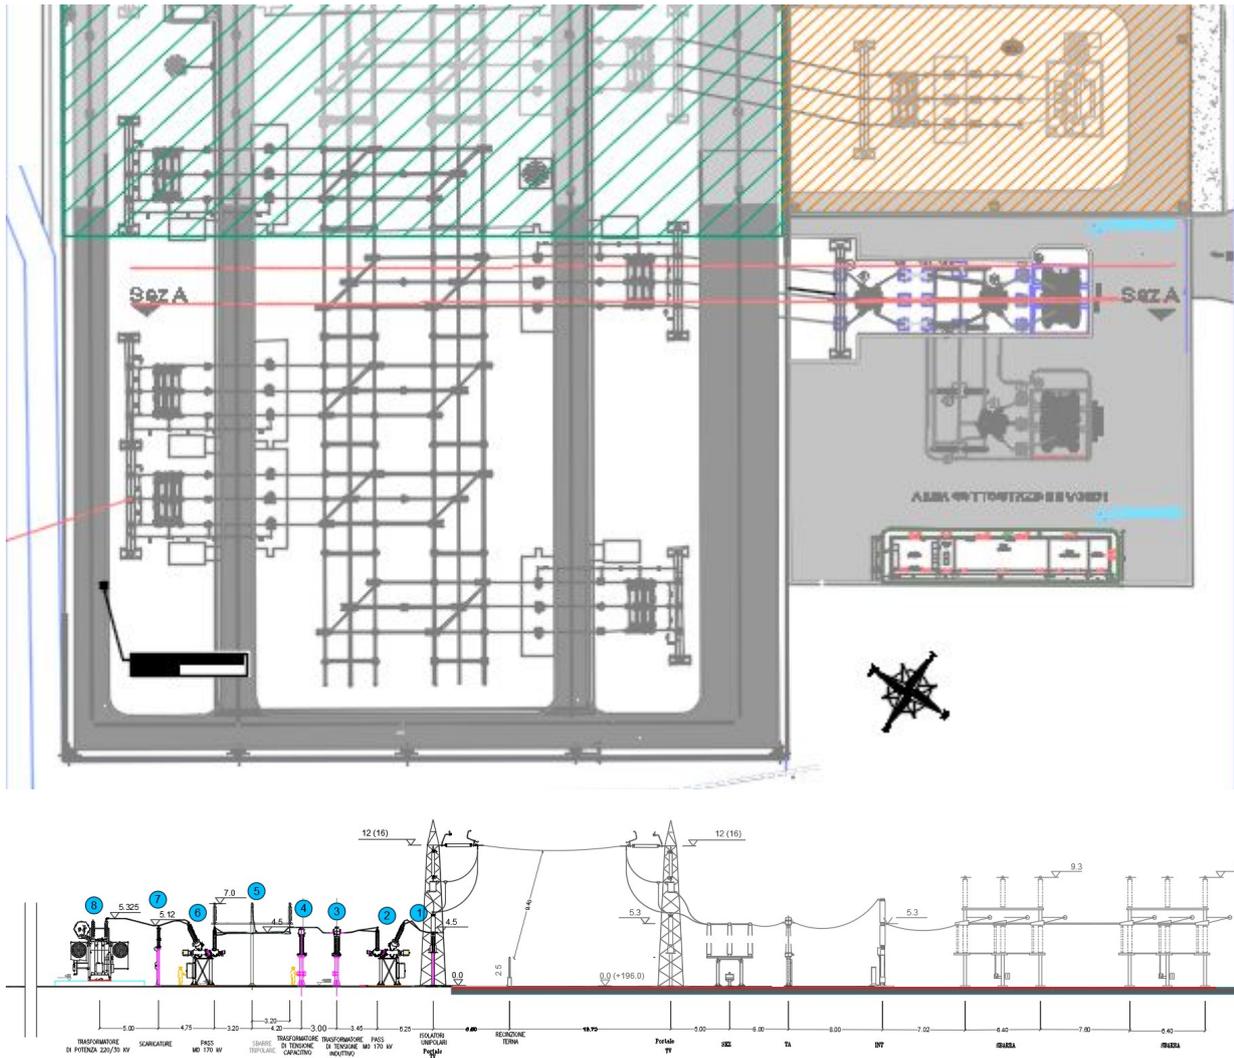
Planimetria e Sezione apparecchiature elettromeccaniche
